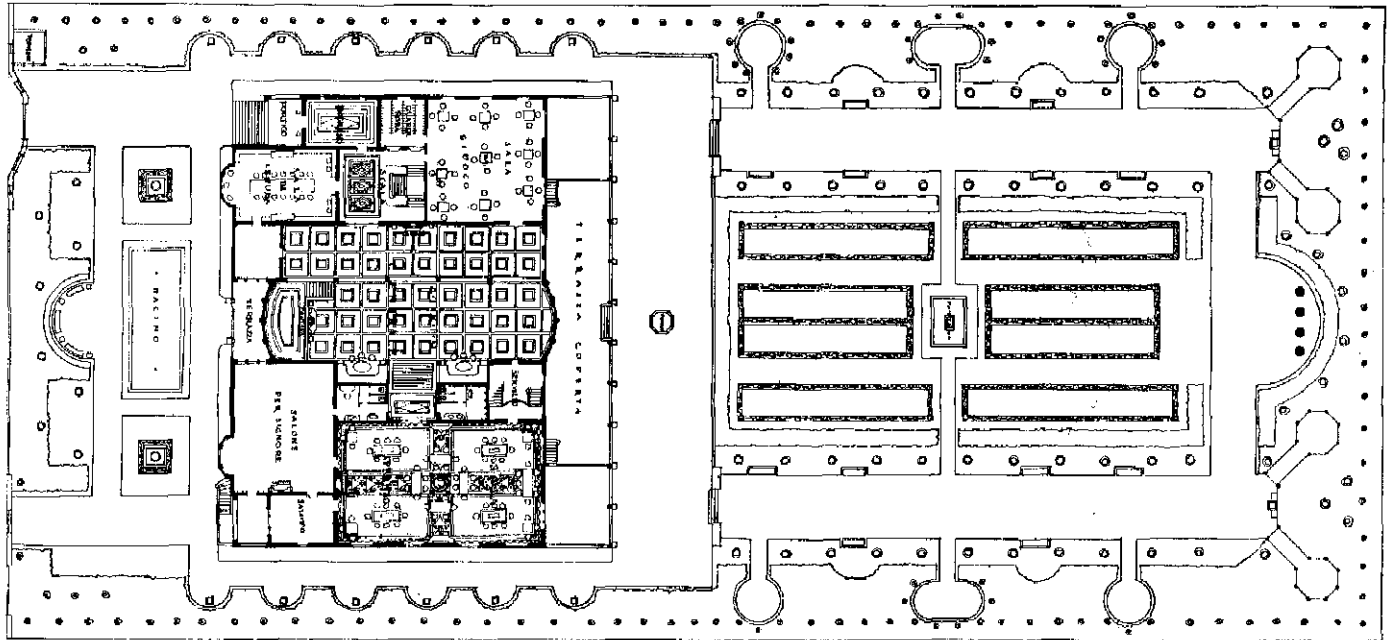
/ Grundriß zu dem auf Seite 207 dargestellten Klubhaus / Architekt: Giuseppe Vago, Rom
